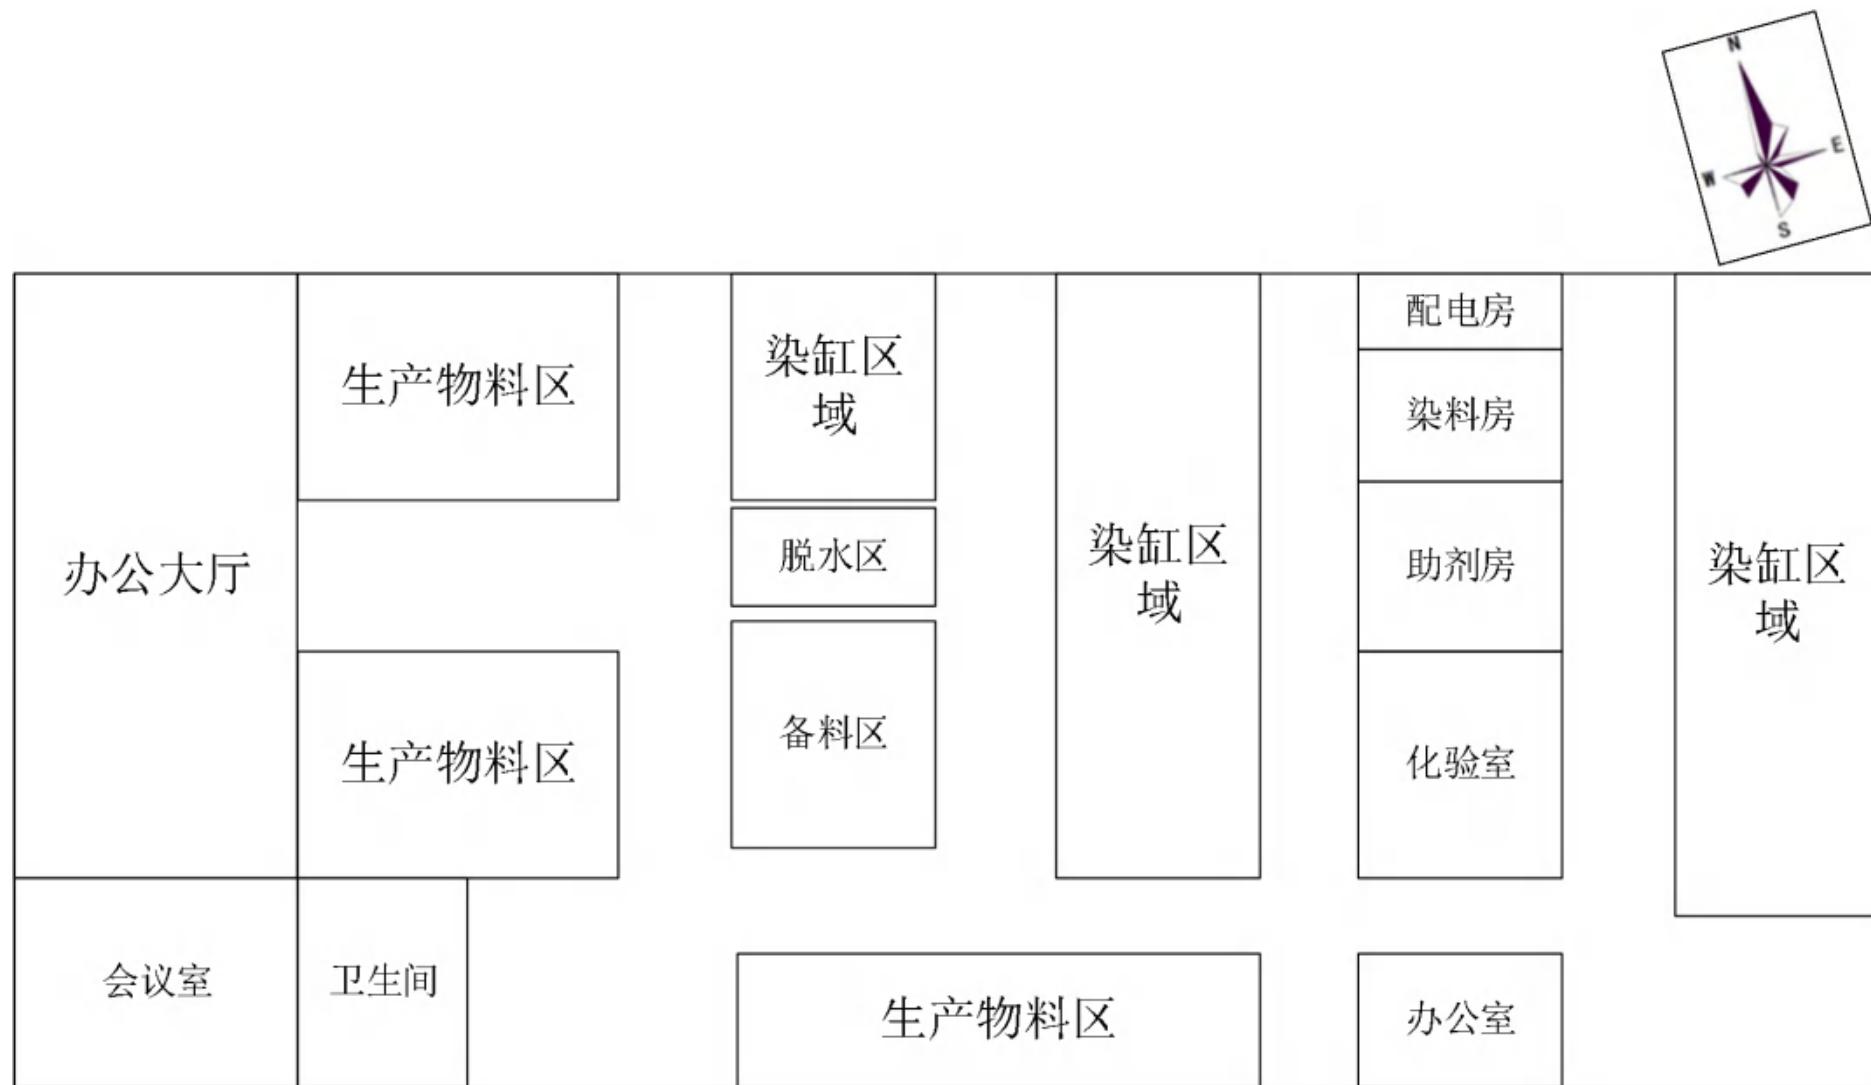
技改扩建后生产车间平面布置图（厂房 A 第一层）
